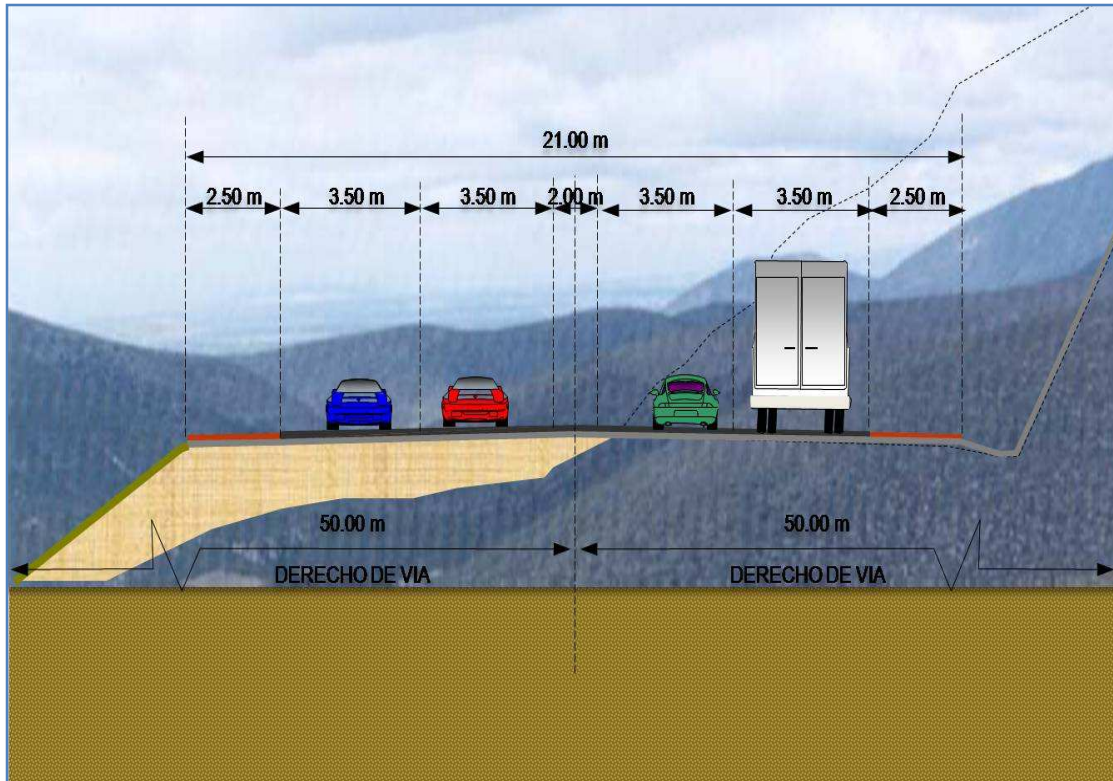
SECCIÓN TIPO PARA CAMINO ABIERTO Y ESTRUCTURAS.
